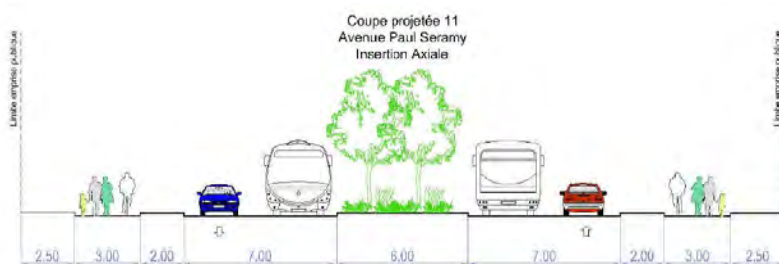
Coupe projetée sur l'avenue Paul Séramy – Source : SYSTRA
